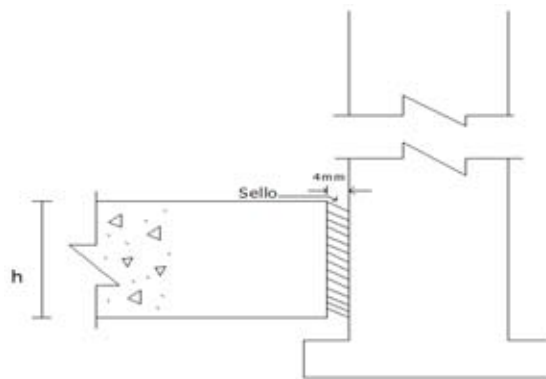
Juntas de dilatación para pavimentos rígidos.
